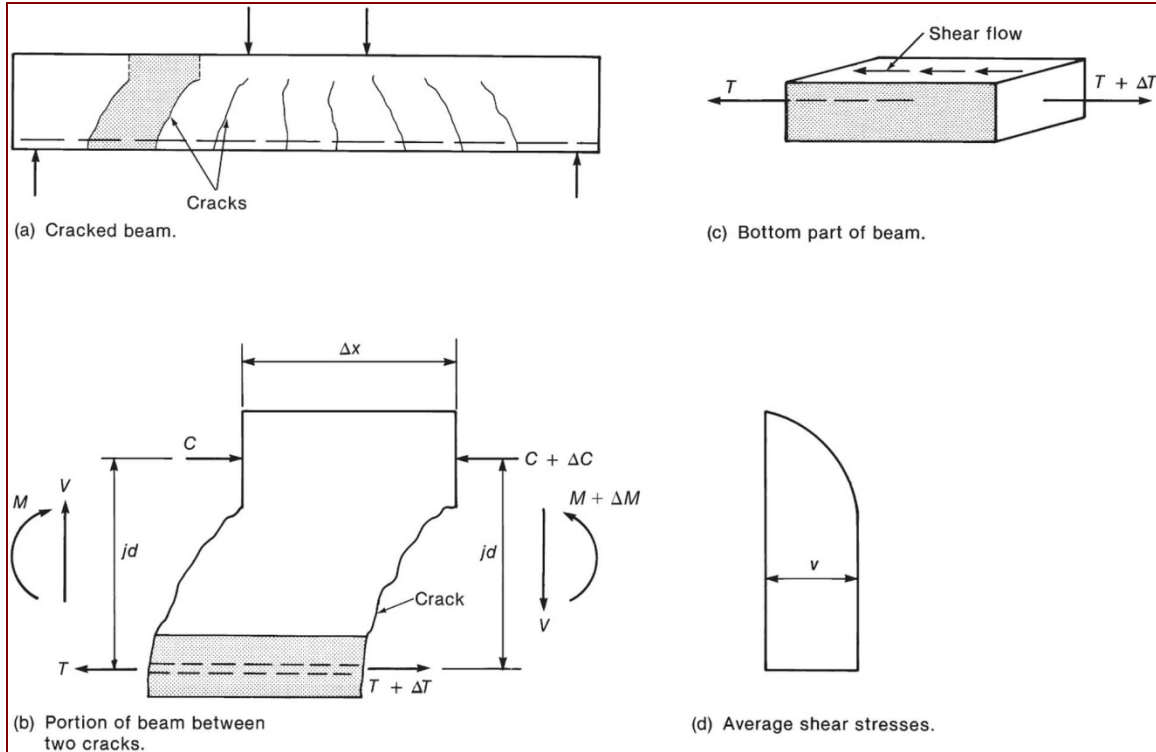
Cálculo del esfuerzo promedio entre grietas.
